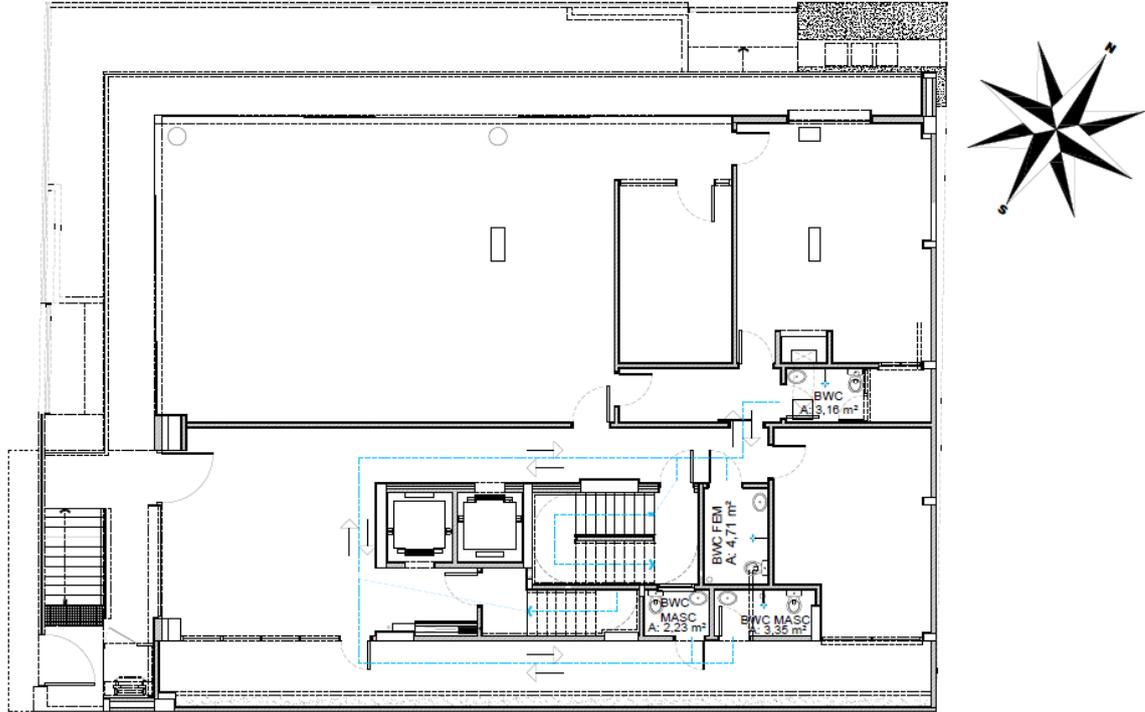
Canteiro de obras – obra 1, Semienterrado.
